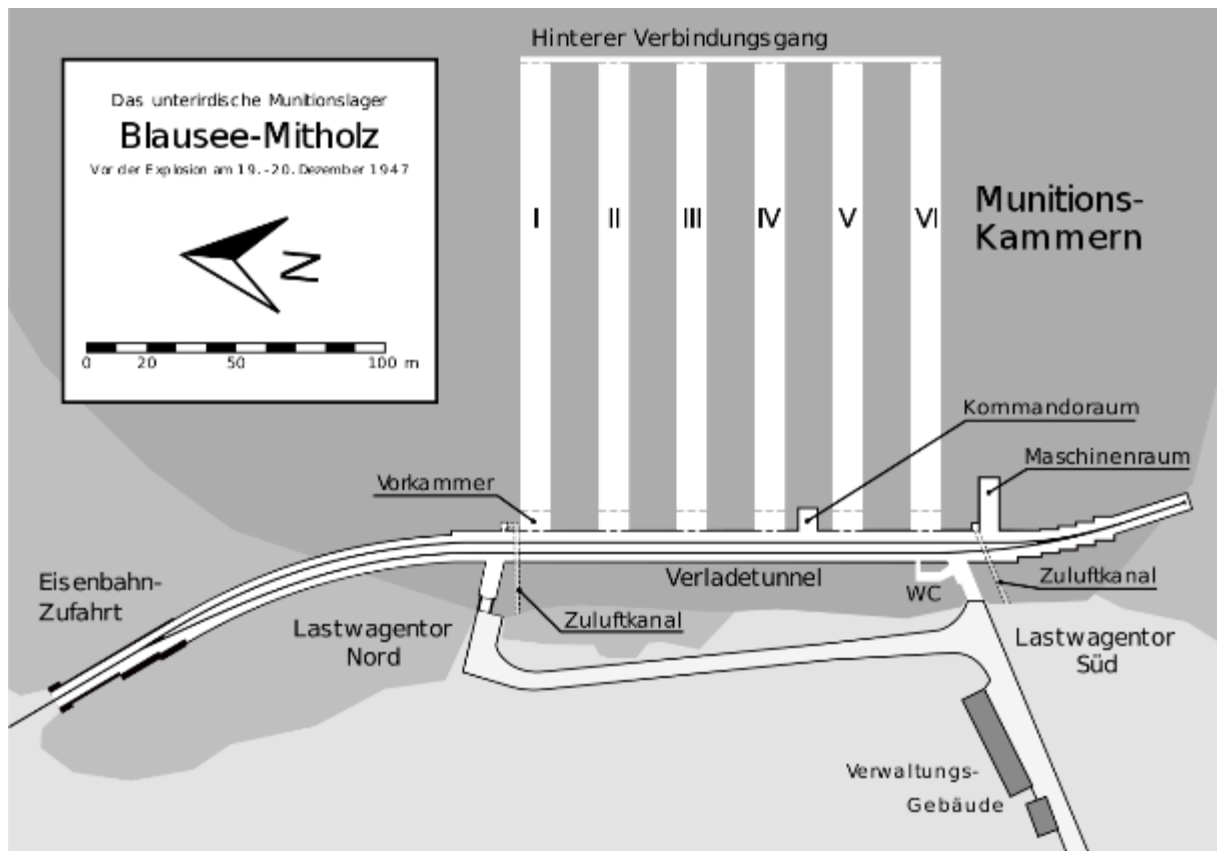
Grundriss der Anlage kurz vor dem Explosionsunglück (1947)
